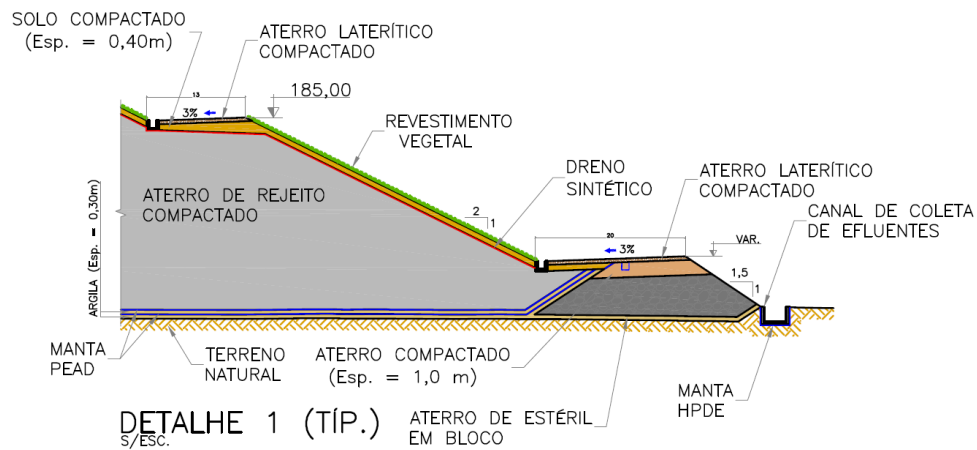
Detalhe 1 da Seção B-B' mostrando detalhes de estruturas previstas para a Pilha 1 (GEOMINAS, 2017a)
